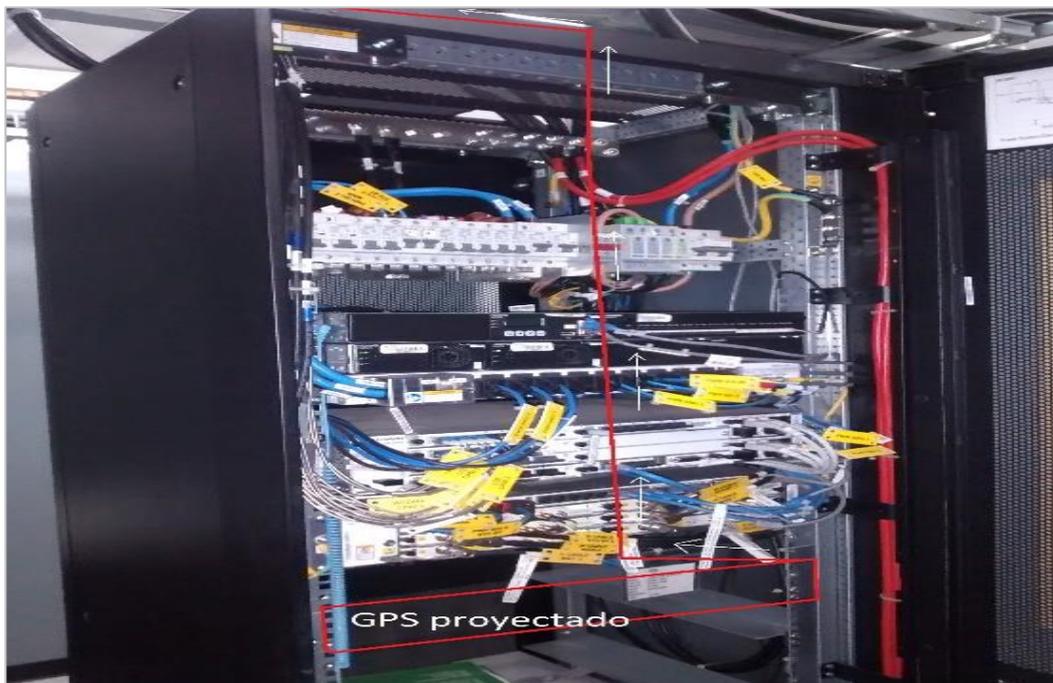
Ubicación de ODF proyectado Site San Marcos
